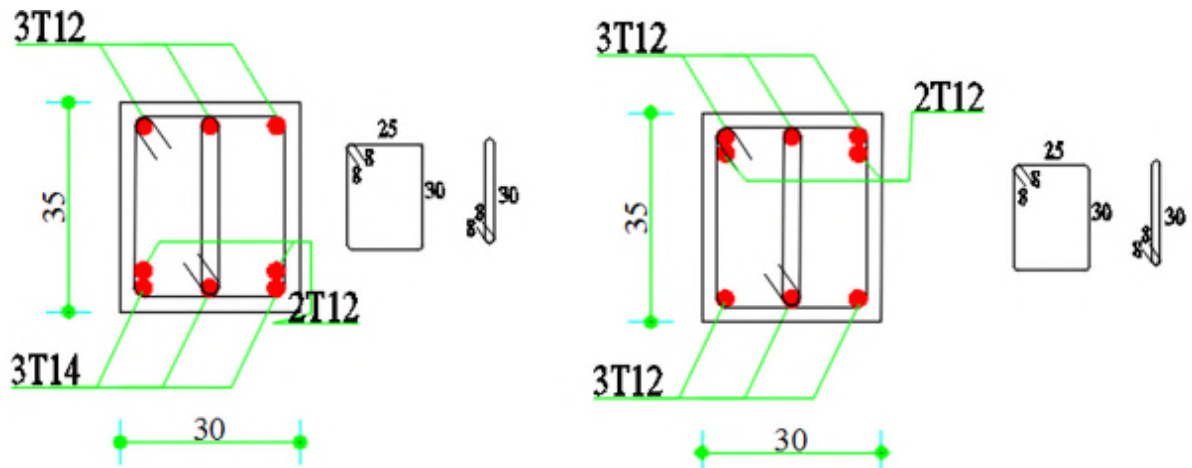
Schéma de ferrailage de la poutre secondaires de ES1-2
